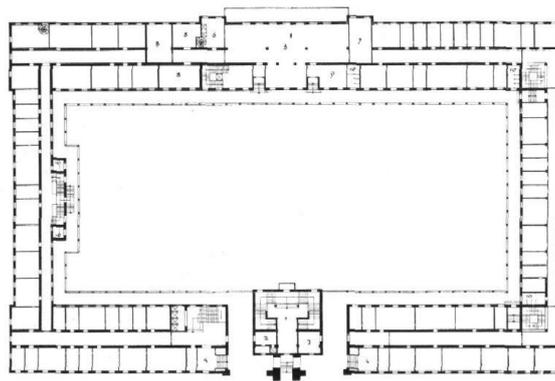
Clemens Holzmeister, Verteidigungsministerium Ankara, Grundriss, 1927-1930.
